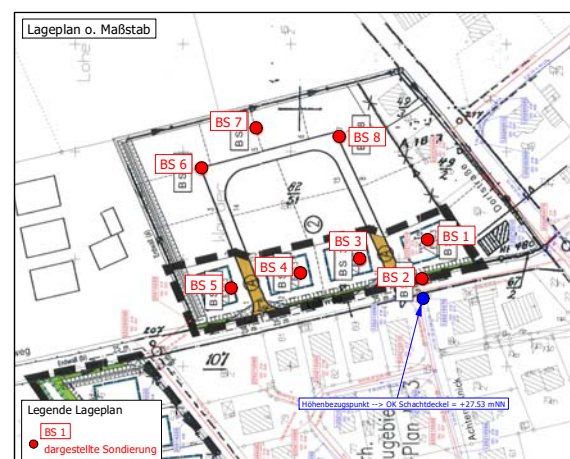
Lageplanausschnitt (o. M.) Bohrungen aus 2011
